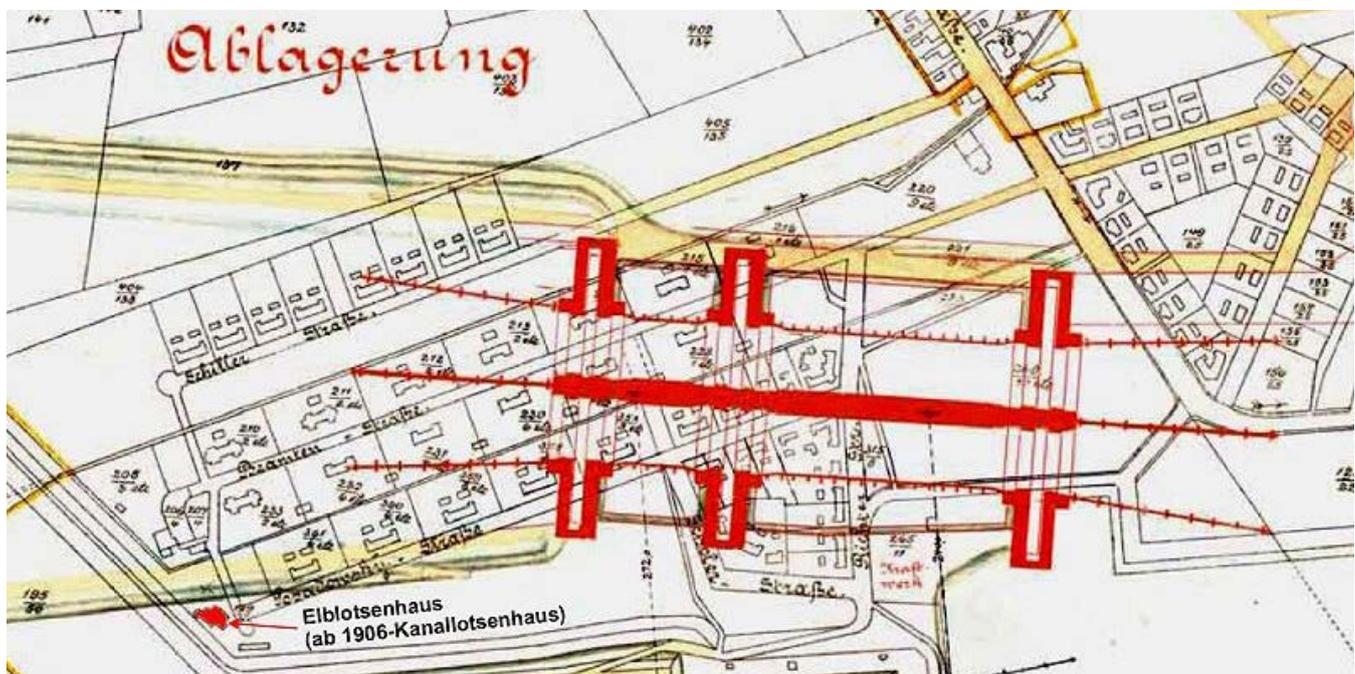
Lage der neuen Schleusenanlage (in rot) und der ersten Beamtenkolonie
